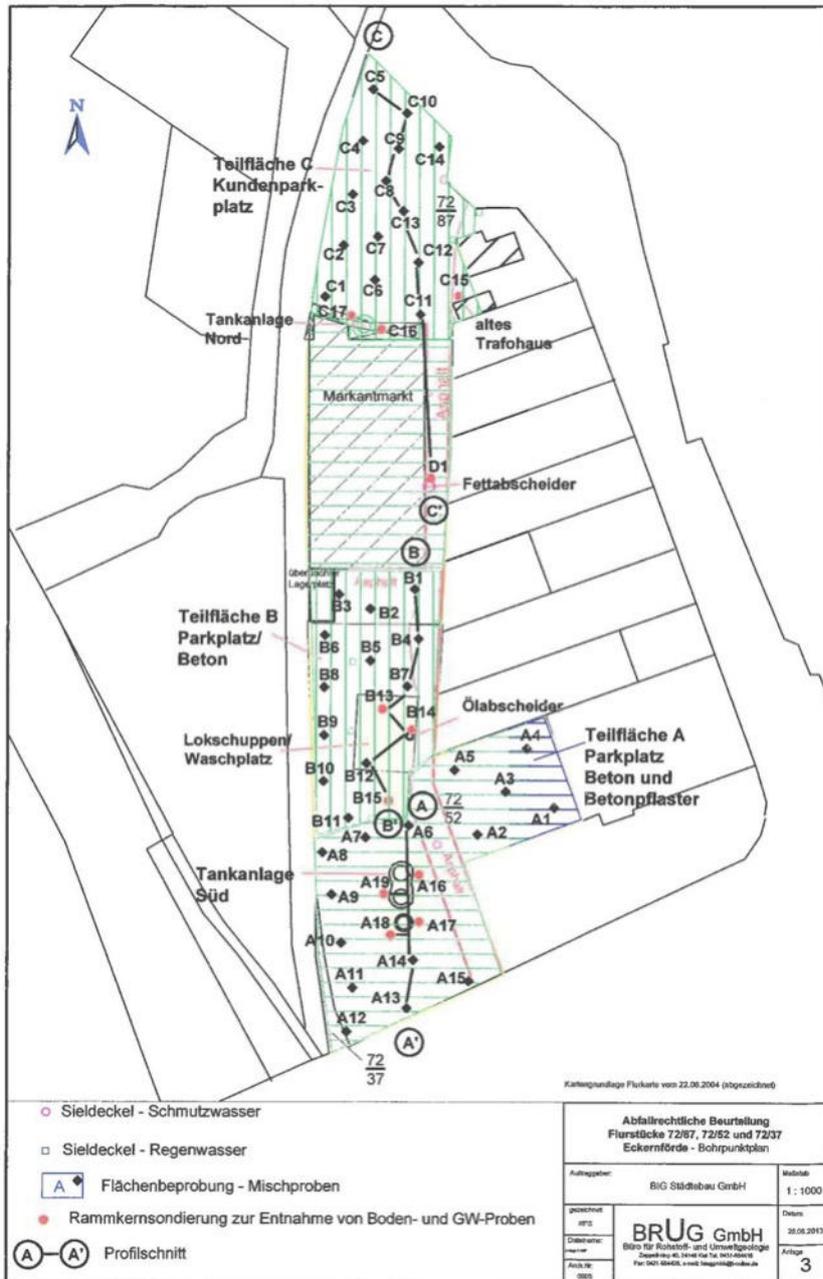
Lageplan Flurstücke 72/87, 72/52, 72/37; Abfallrechtliche Beurteilung BRUG 2013
